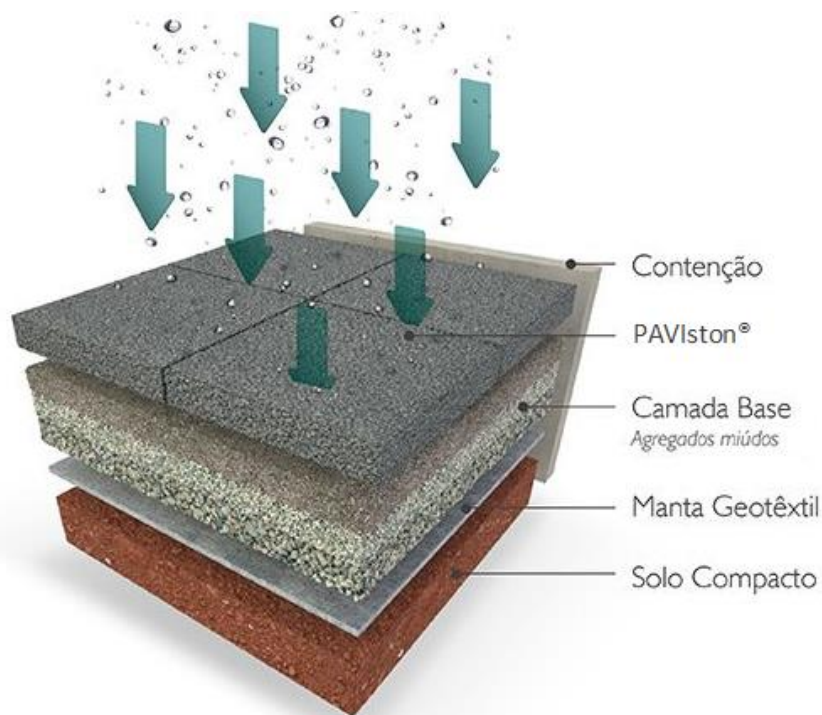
Corte de um pavimento poroso da PAVIston. (ver ficha técnica). Fonte: (Construção., s.d.).
